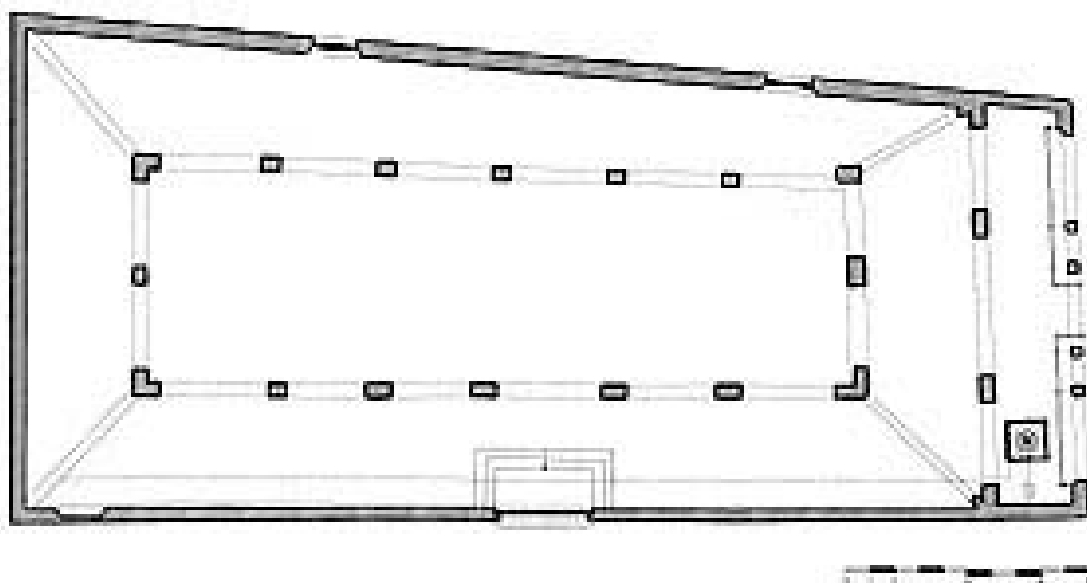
Esquema en Planta de la Evolución constructiva. Fuente Web: ViA arquitectura
